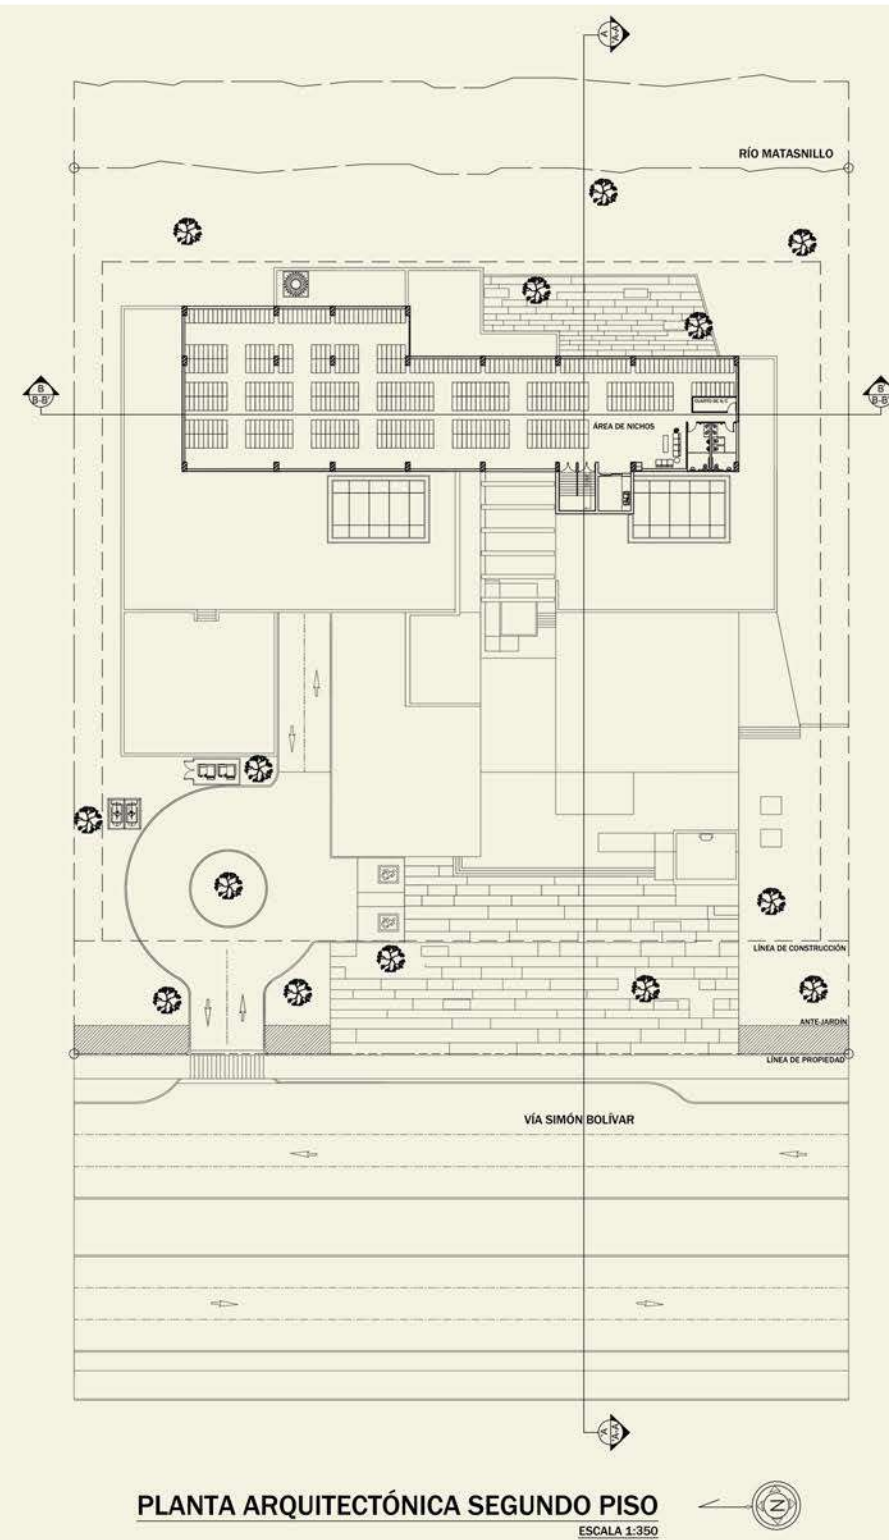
Planta Arquitectónica segundo piso. (Escala para plano 2x3)
